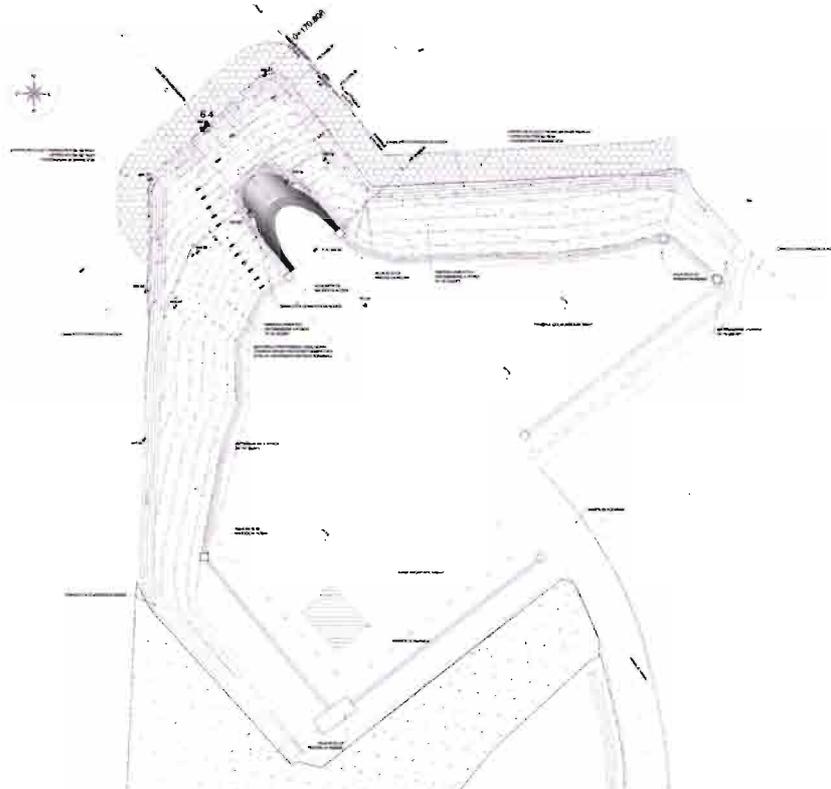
Stralcio planimetrico imbocco Albes
